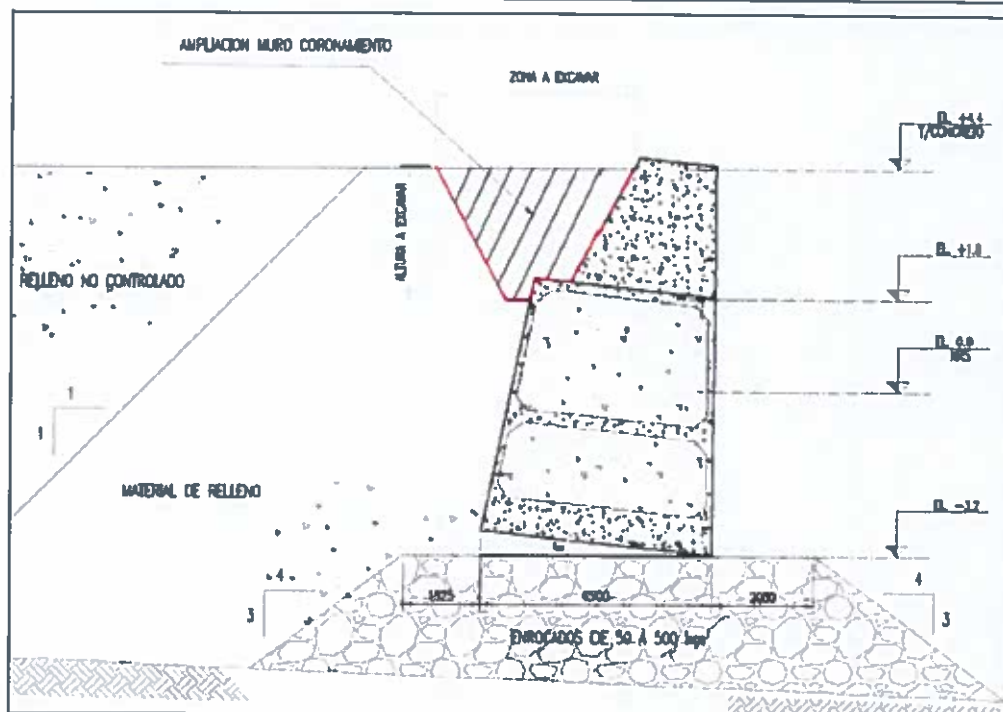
Esquema de alternativa de restitución de muros Sitio N° 1 con hormigón
